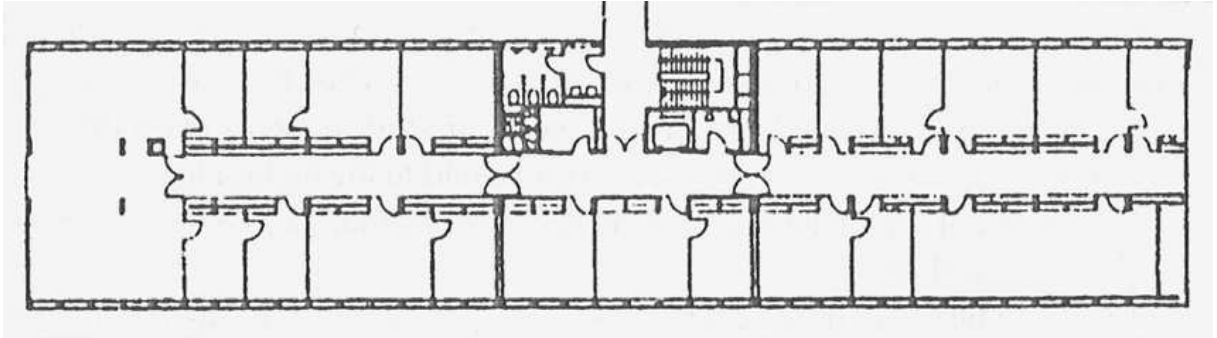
Fabrika Büro Plan Tipine Örnek
